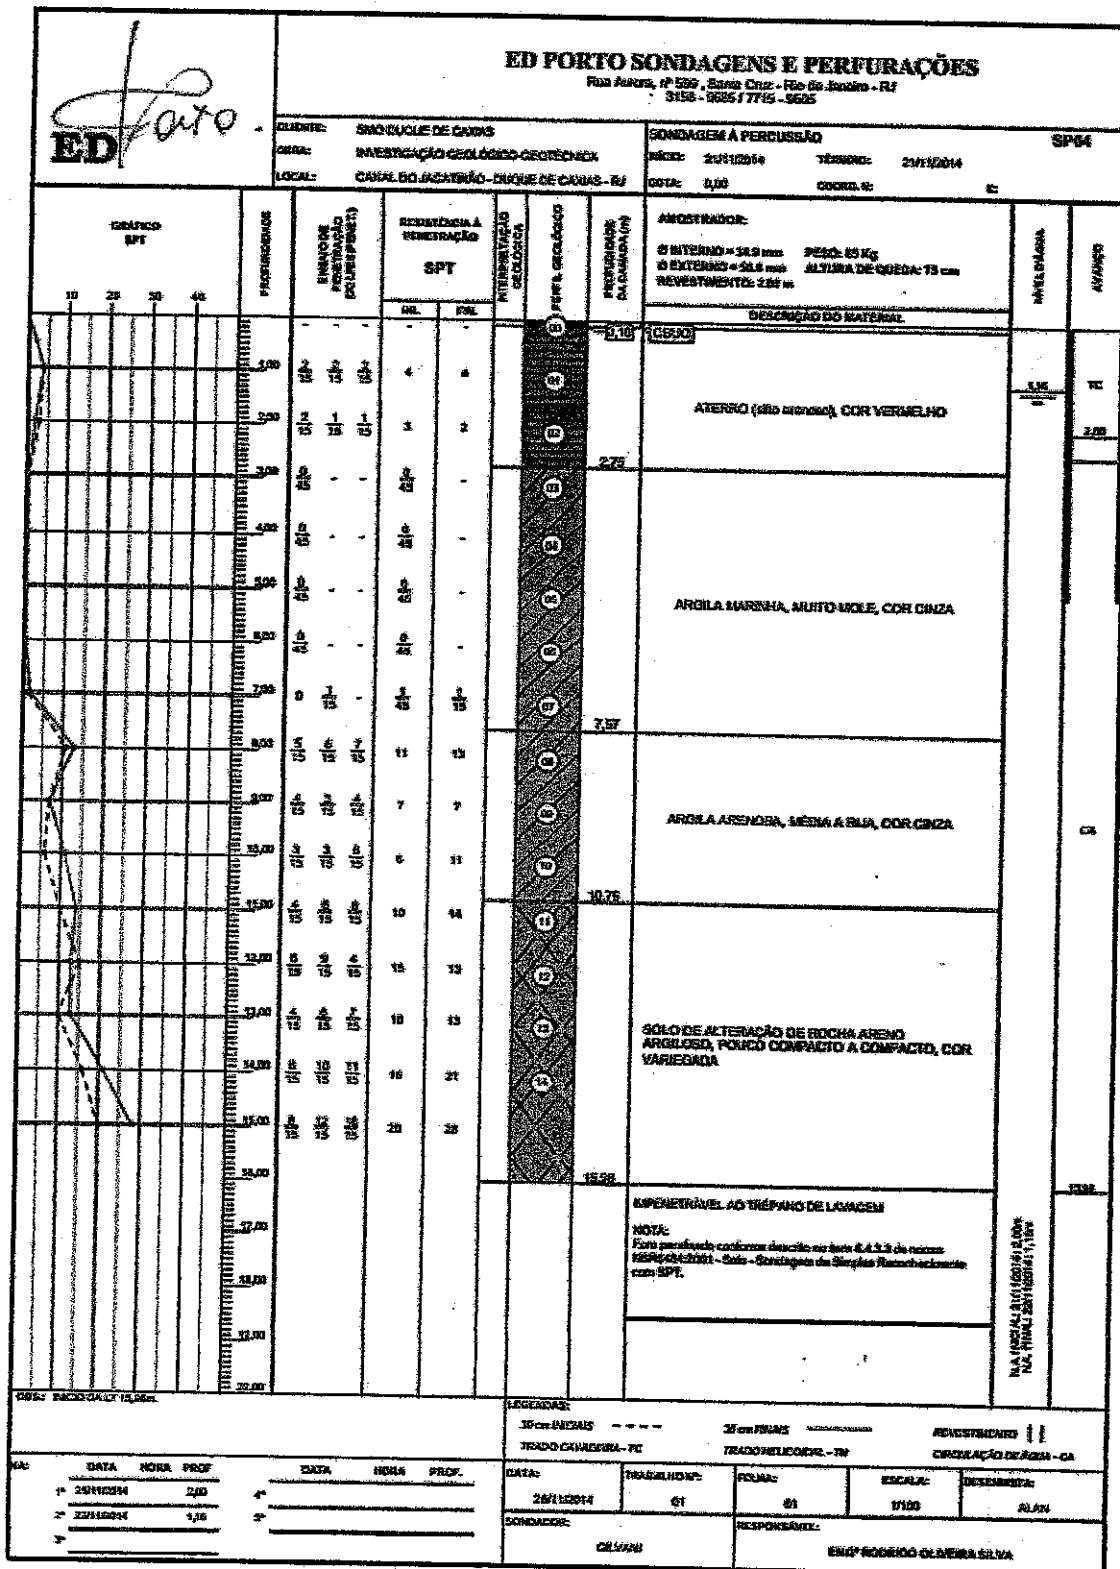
Perfil de sondagem SP-04 (Parte 1/1)
